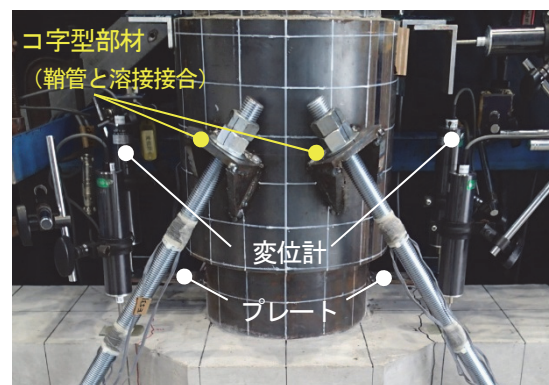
コ字型部材の設置状況と計測プレートおよび変位計
